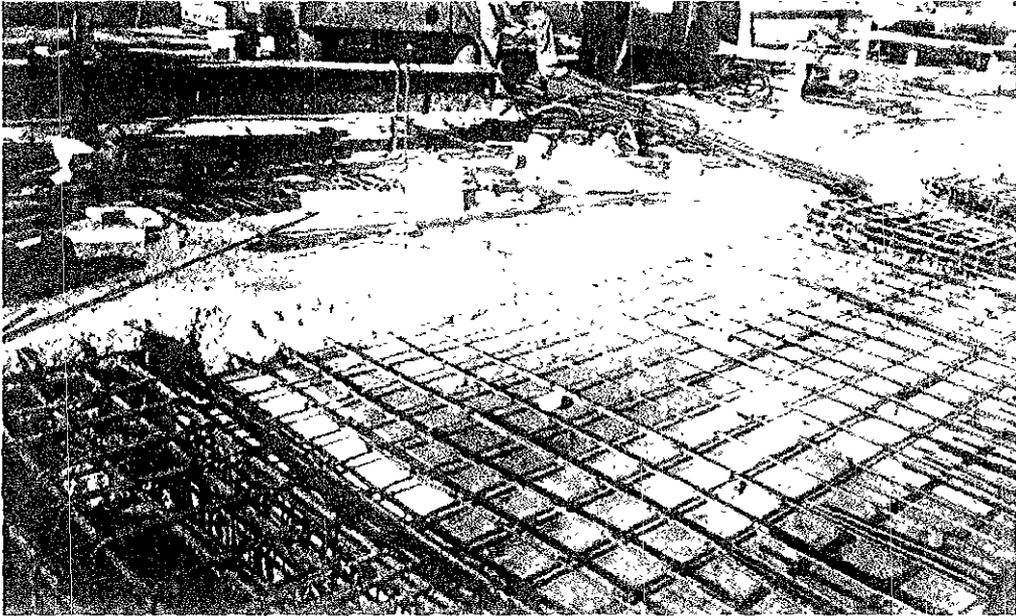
Mcculo de losa colada , donde se presentara una junta de construcción.
